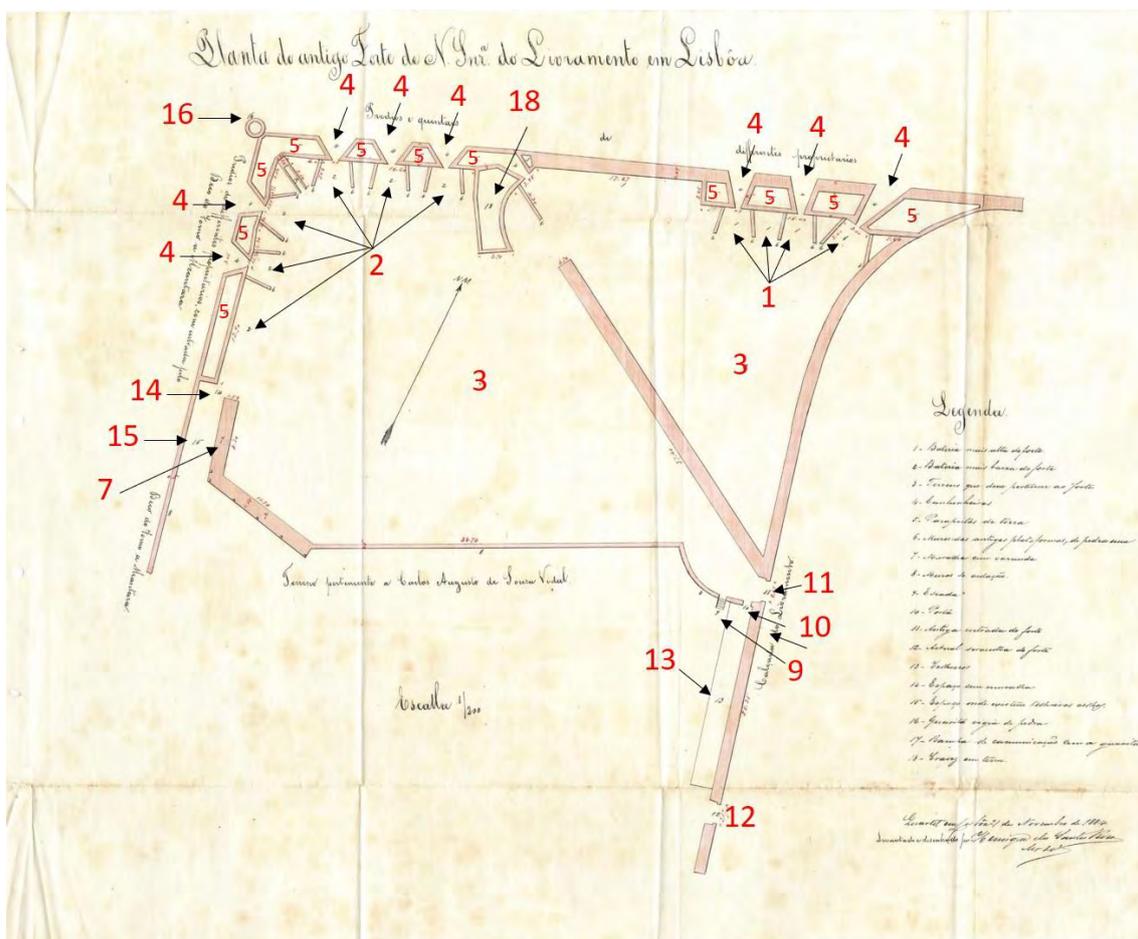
Legenda: 1 – Bateria mais alta do forte, 2 – Bateria mais baixa do forte, 3 – Terreno que deve pertencer ao forte, 4 – Canhoneiras, 5 – Parapeitos de terra, 6 – Muros das antigas plataformas, de pedra seca, 7 – Muralha com varanda, 8 – Muros de vedação, 9 – Escada, 10 – Portão, 11 – Antiga entrada do forte, 12 – Atual serventia do forte, 13 – Telheiros, 14 – Espaço sem muralha, 15 – Espaço onde existem telheiros velhos, 16 – Guarita vigia de pedra, 17 – Rampa de comunicação com a guarita 18 – Travez⁴² em terra.
